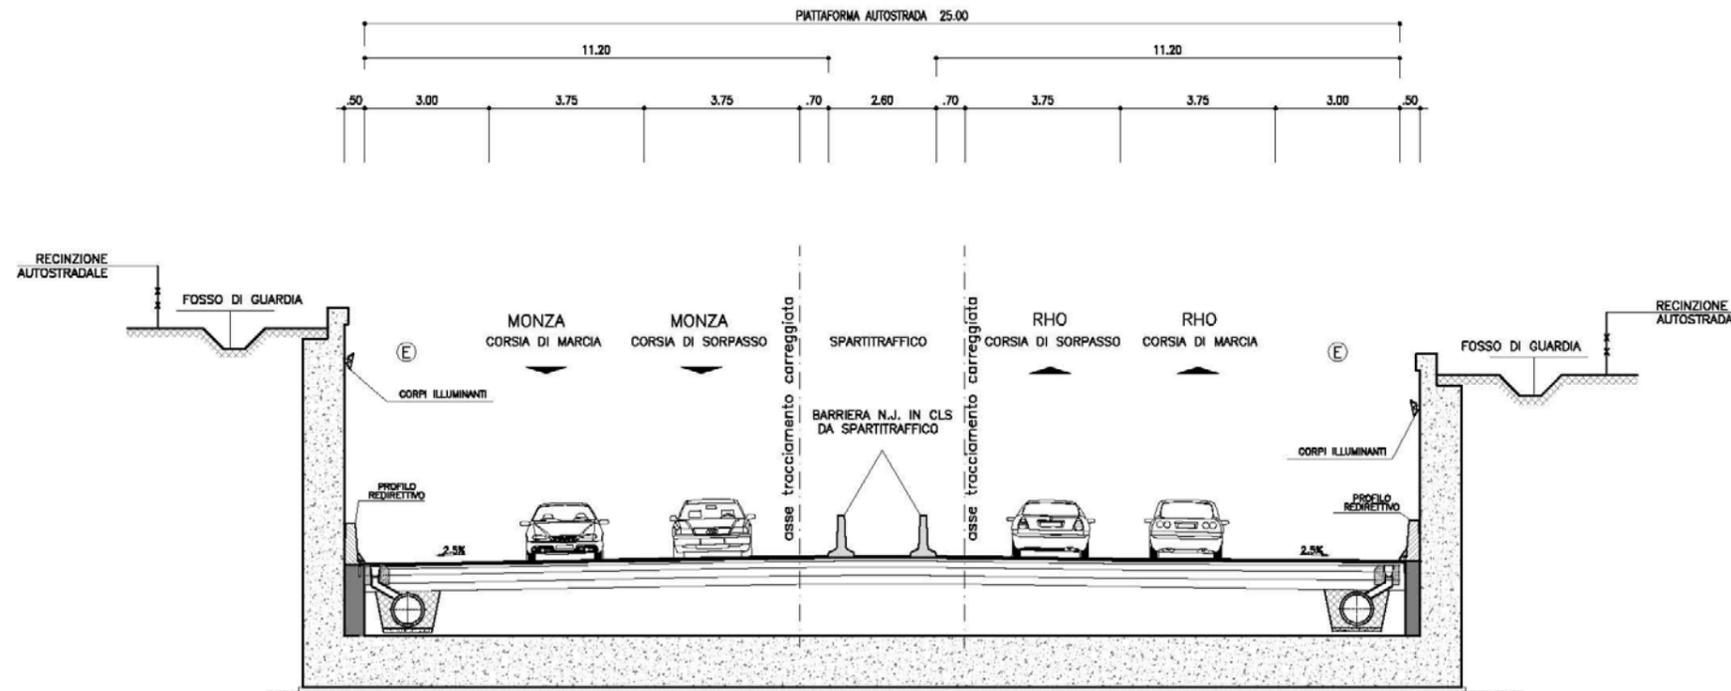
Tracciato in trincea – Sezione con Muri U
